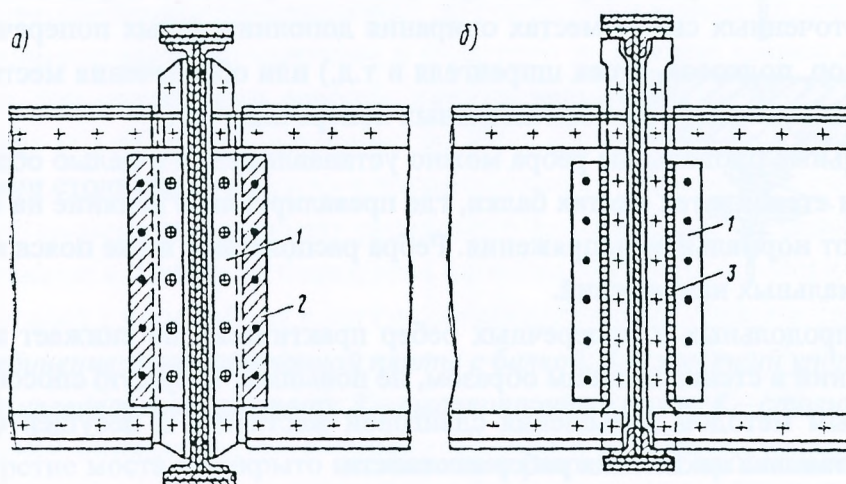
Усиление прикреплении продольных балок к поперечным обычными (а) и приваренными накладками (б): 1 – накладка; 2 – прокладка; 3 – сварной шов.
